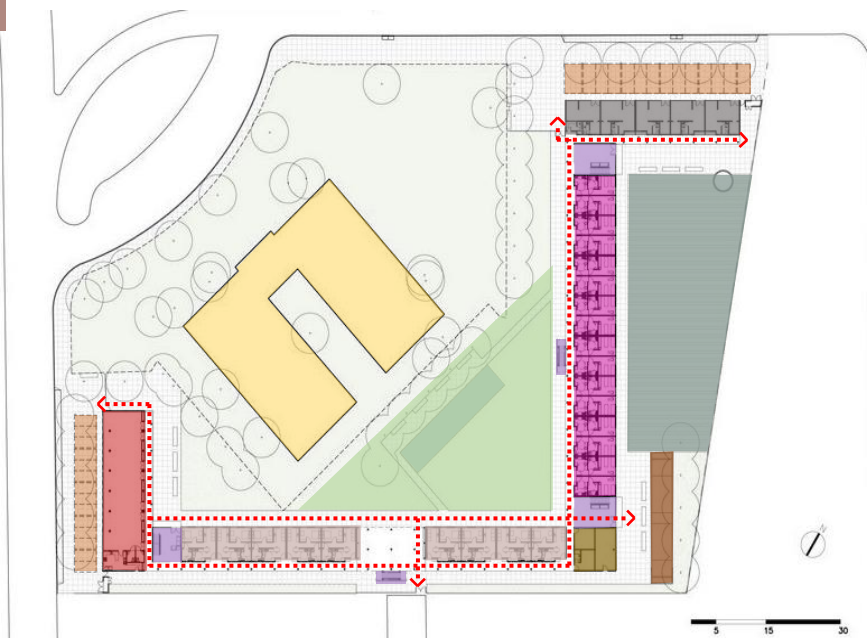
Planta térreo com setorização. Fonte: Vigliecca. Esquema elaborado pela autora. 2020
